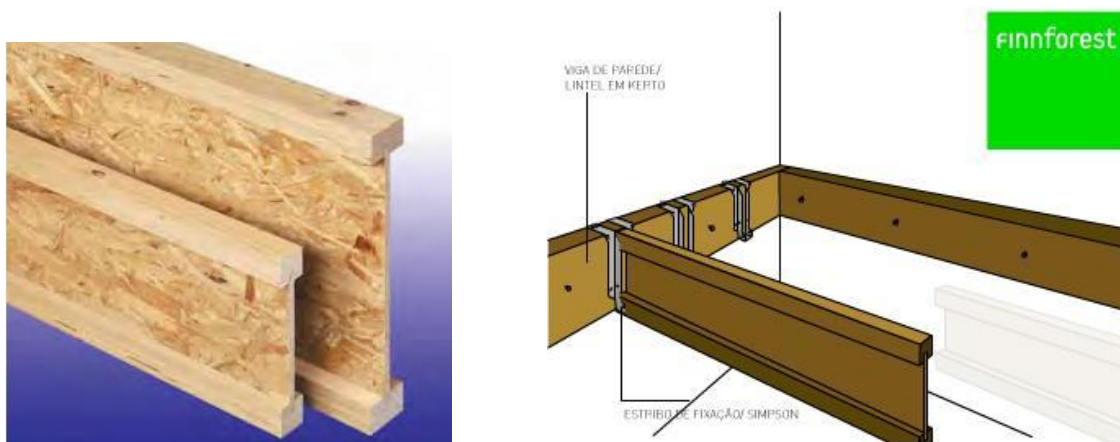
Vigas Finnjoist e esquema de colocação utilizando estribo de fixação Simpson [23]
